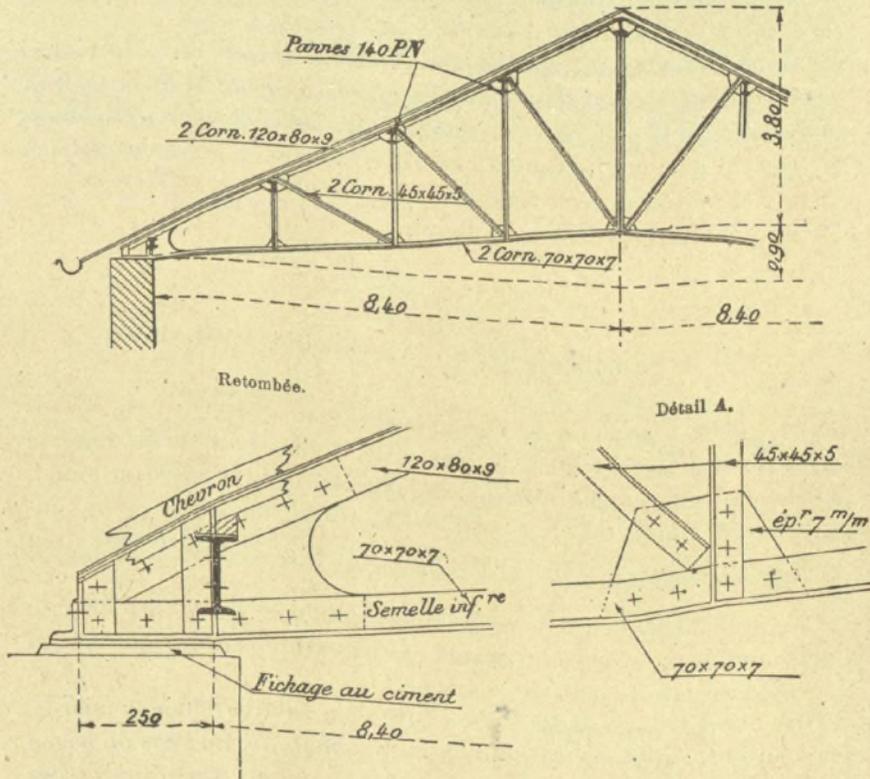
Détail d'une ferme de 16,80 m. Élévation.
